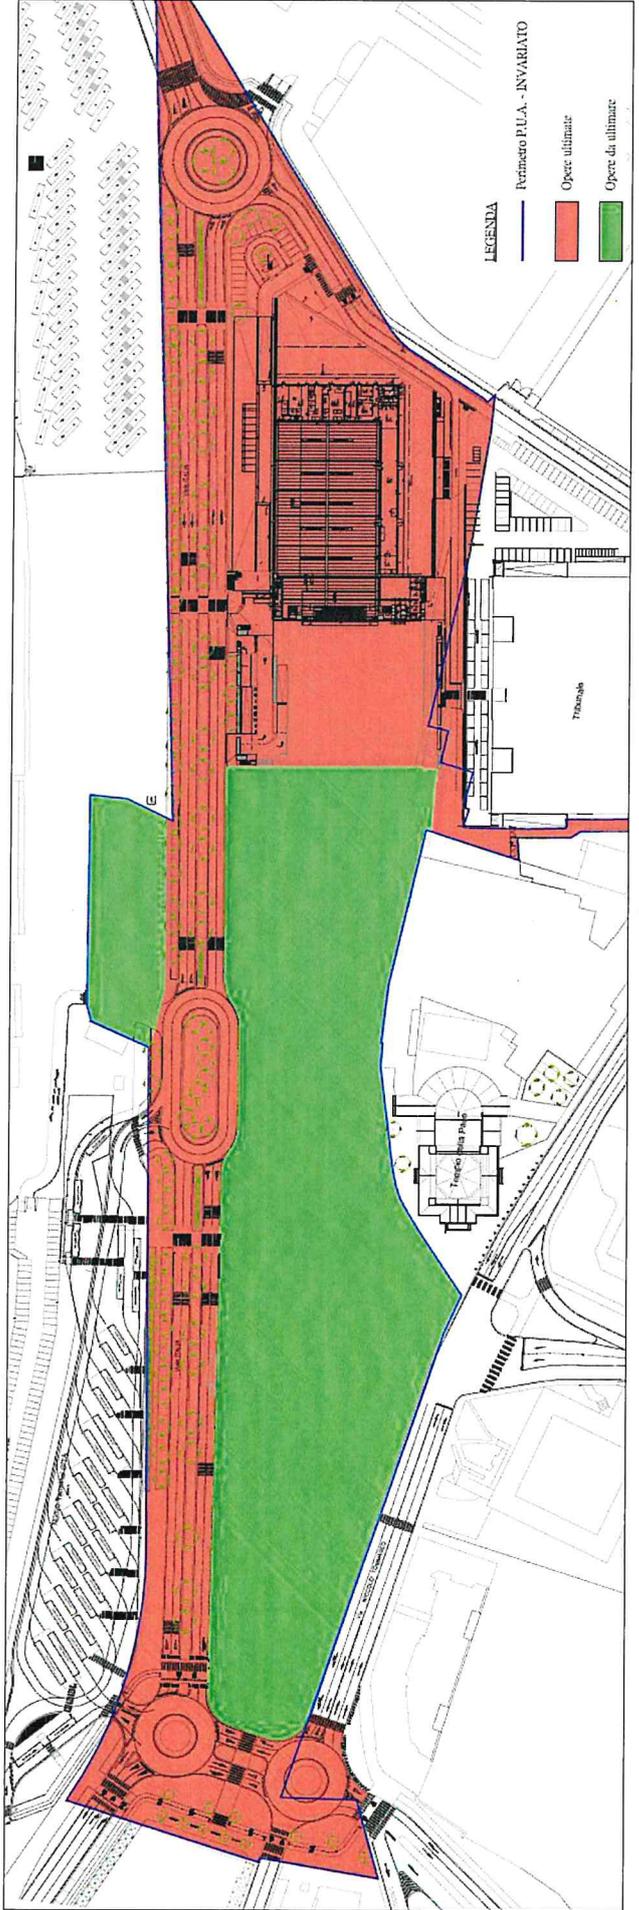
Estratto Tavola 02 Stato di attuazione delle opere
